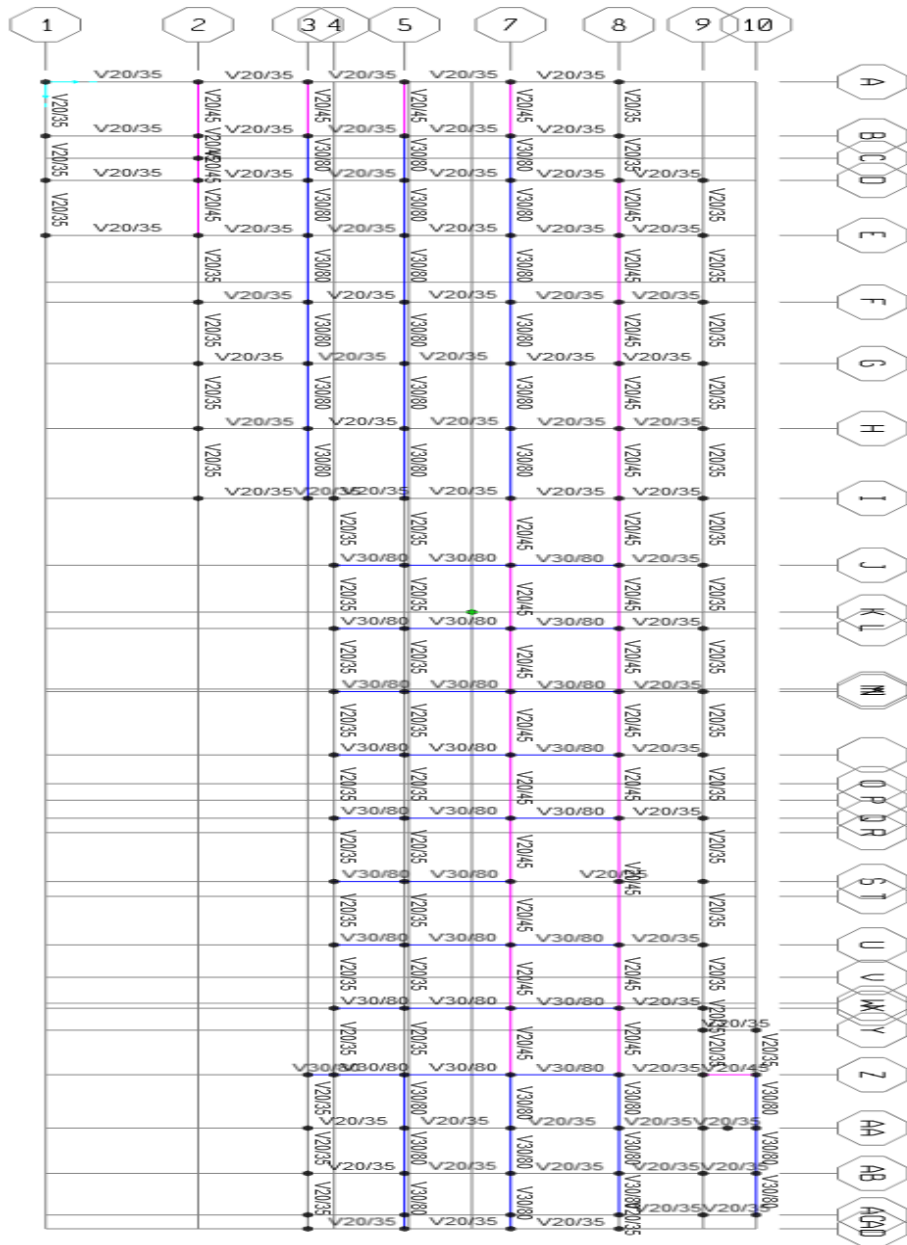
Vista 1ra. Planta e identificación de elementos bloque B del Vicente Rocafuerte.
